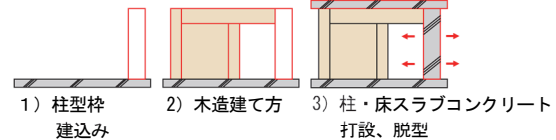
平面混合構造（木造+鉄筋コンクリート造）の施工手順
